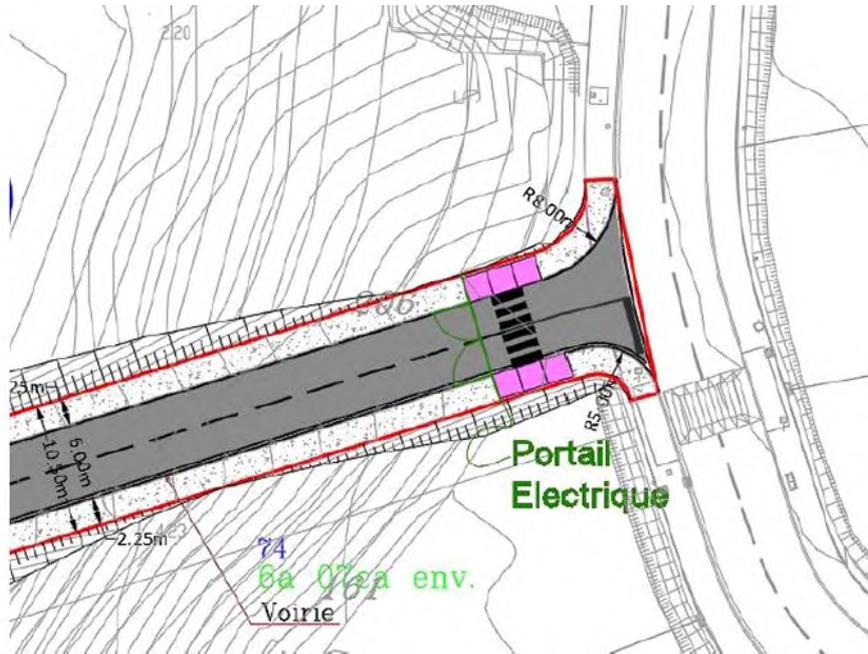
plan de détail de l'accès sur le lotissement (source : BECIB)
